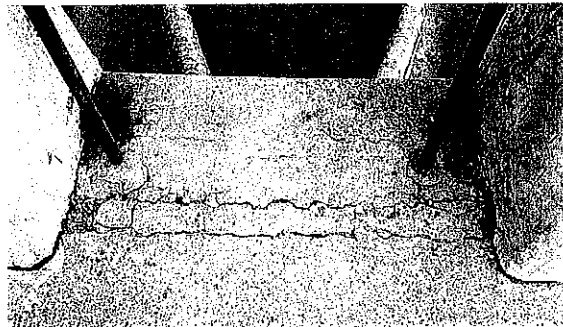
y 11: Fisuras observadas en el tablero del puente
